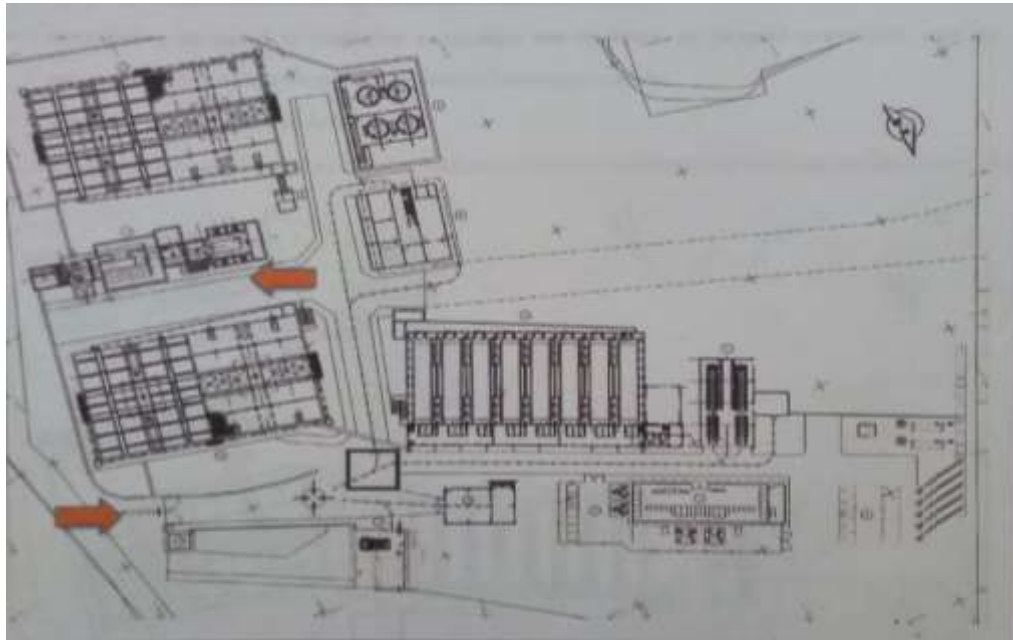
Plano de ubicación de la planta potabilizadora, ruta de acceso del camión y lugar de descarga.
